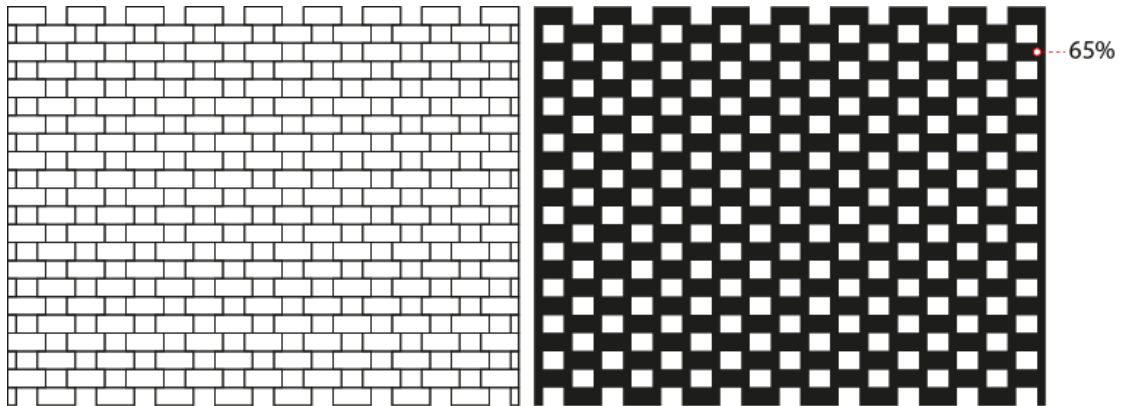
Sistema constructivo de la envolvente Pabellón experimental del ladrillo.
